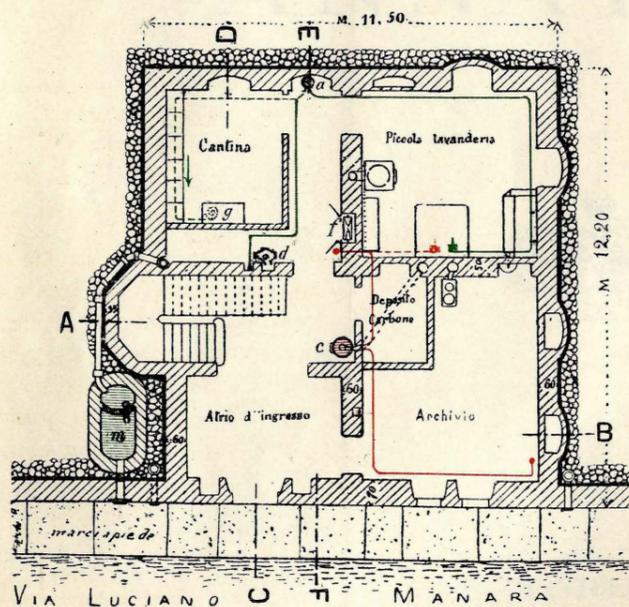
Pianta dei sotterranei (Scala 1:200).
